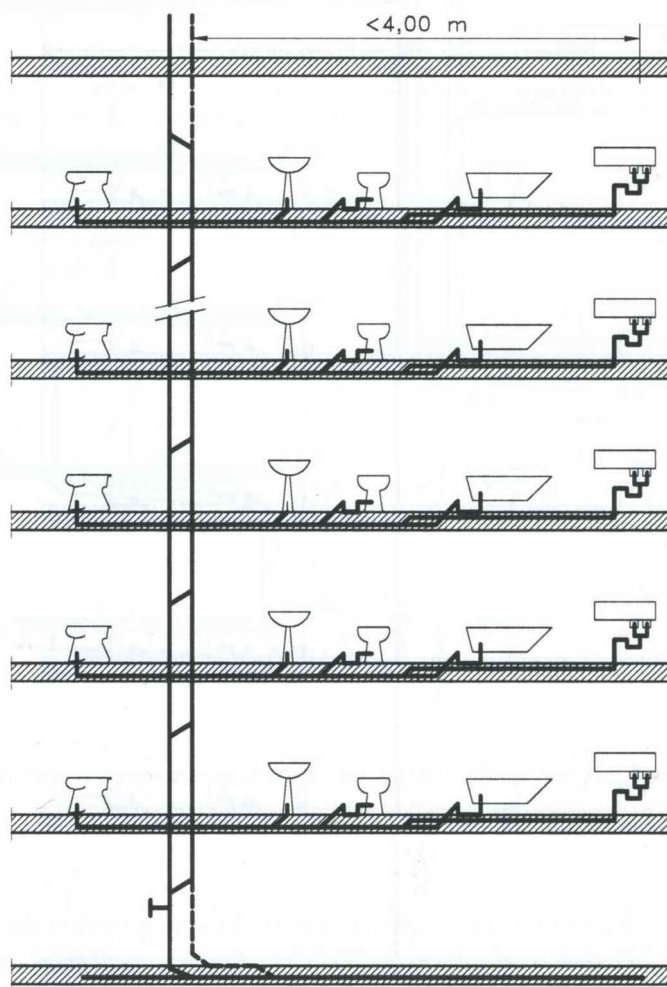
Schema di un impianto di scarico con ventilazione parallela diretta
